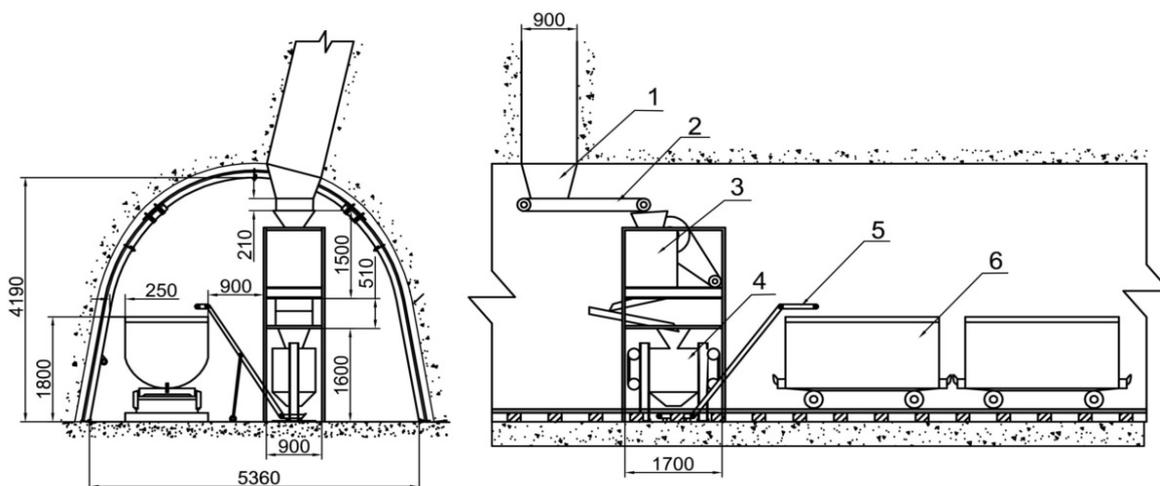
Технологическая схема дробления породы в шахте: 1 – приемная воронка, 2 – пластинчатый питатель, 3 – дробилка щекового типа ДЩ-350-400, 4 – дробилка валкового типа ДВ-270-200, 5 – транспортер жолобобразный ЛТ, 6 – порожняя вагонетка ВГ-3,3
